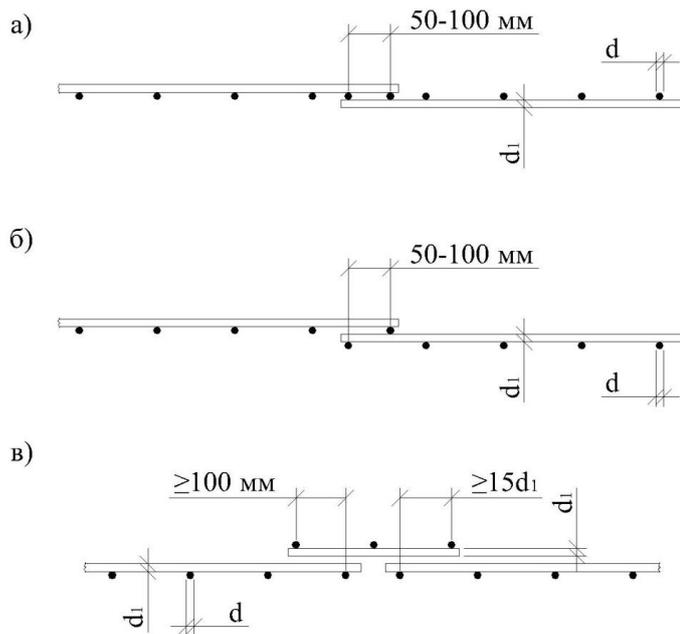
Стыки сварных сеток в направлении поперечной (распределительной) арматуры
